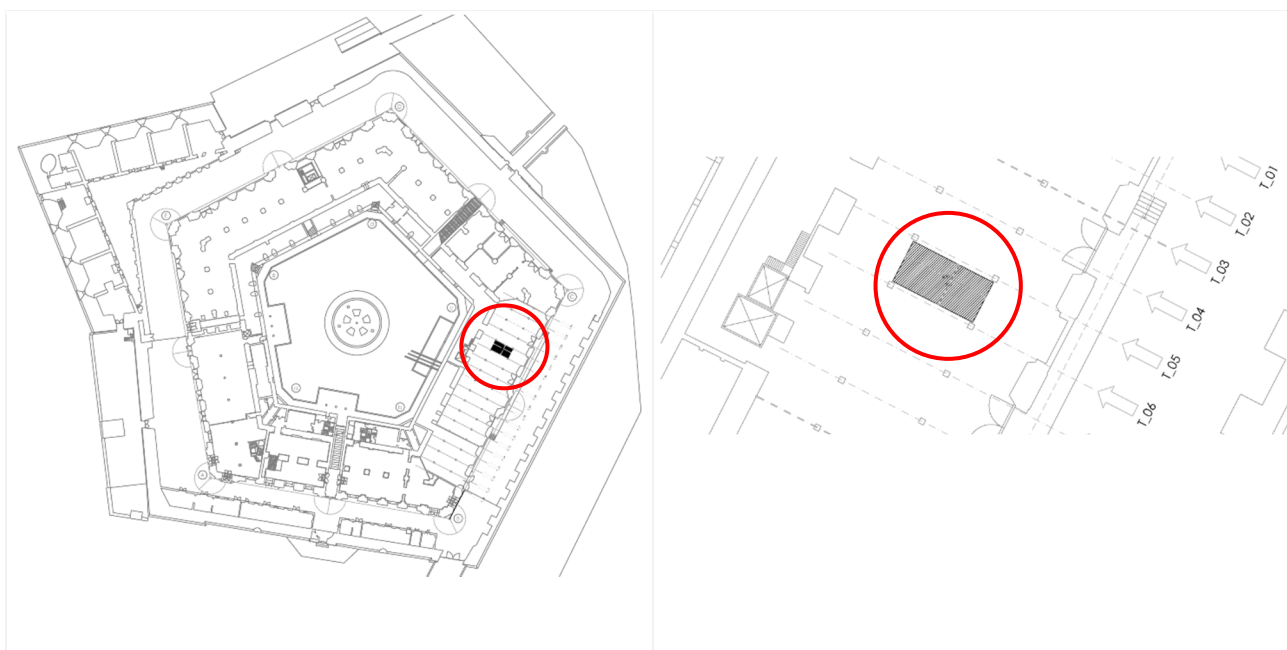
Planimetria e particolare con individuazione del campo di soletta testato
